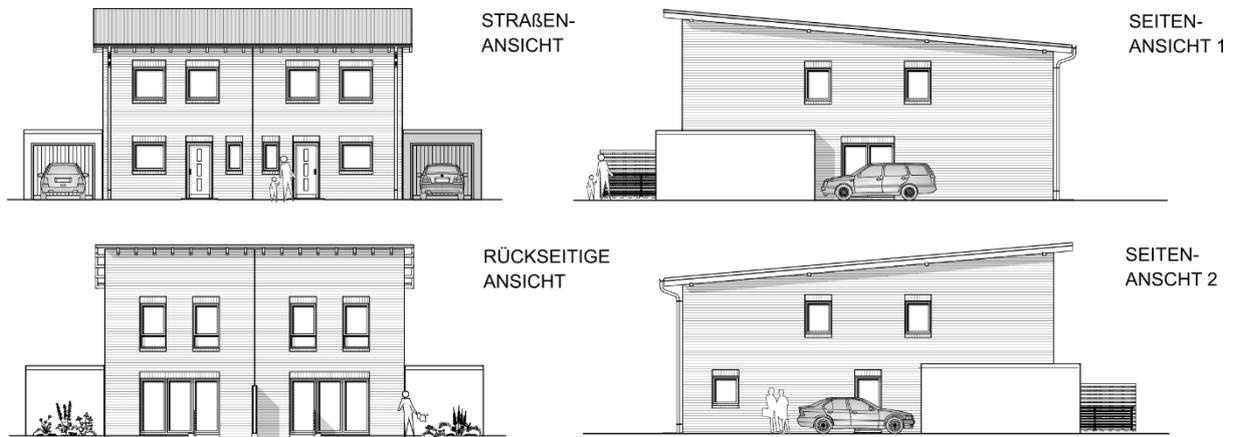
Haustyp Doppelhaus - beispielhafte Ansicht aus allen Richtungen
